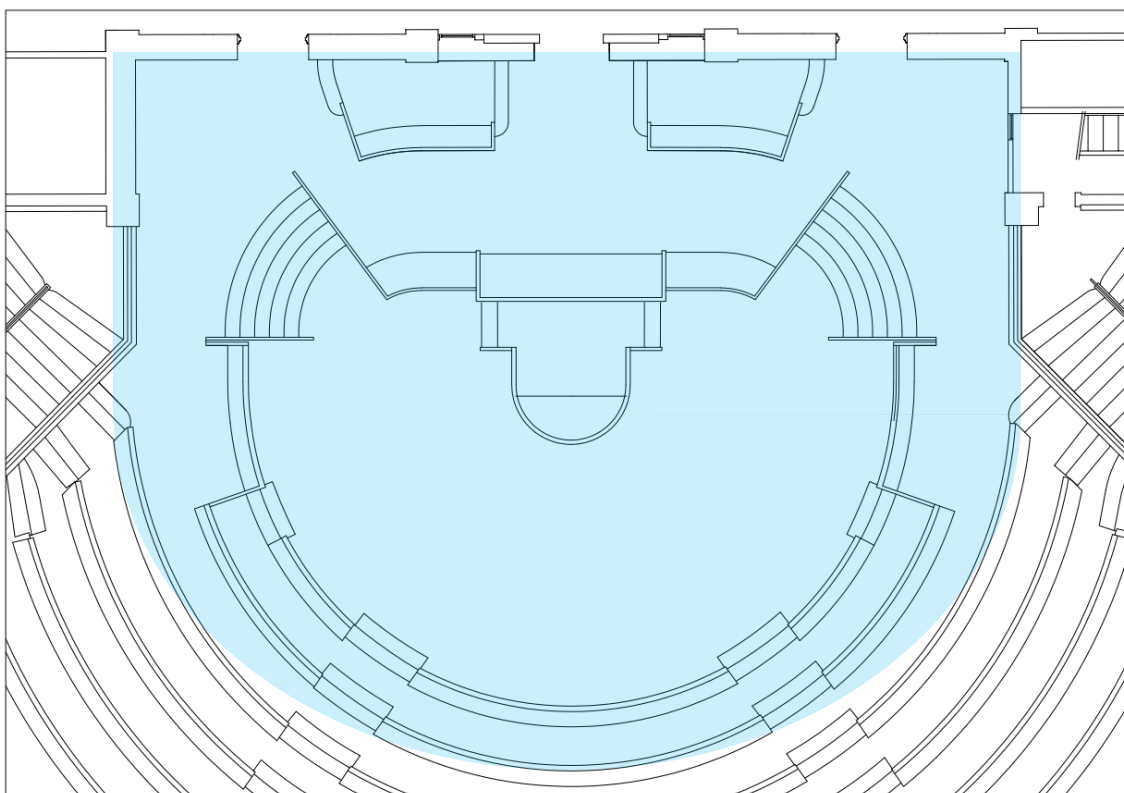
repérage en plan de la zone concernée par l'étude du plancher bas de la tribune présidentielle et du parterre de l'hémicycle
